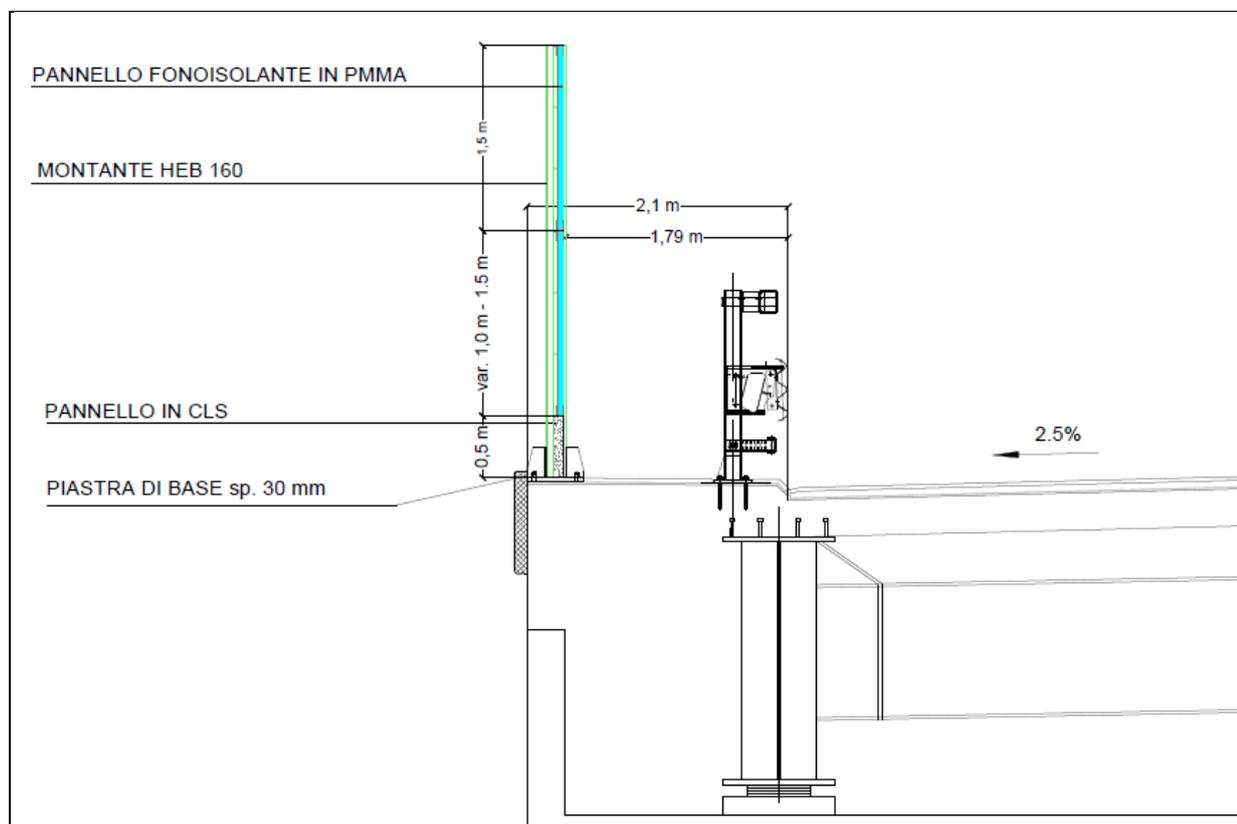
PROSPETTO TIPO BARRIERA ANTIRUMORE TRASPARENTE CON PANNELLI IN PMMA DI DIMENSIONI 3X1 E 3X1,5 M
